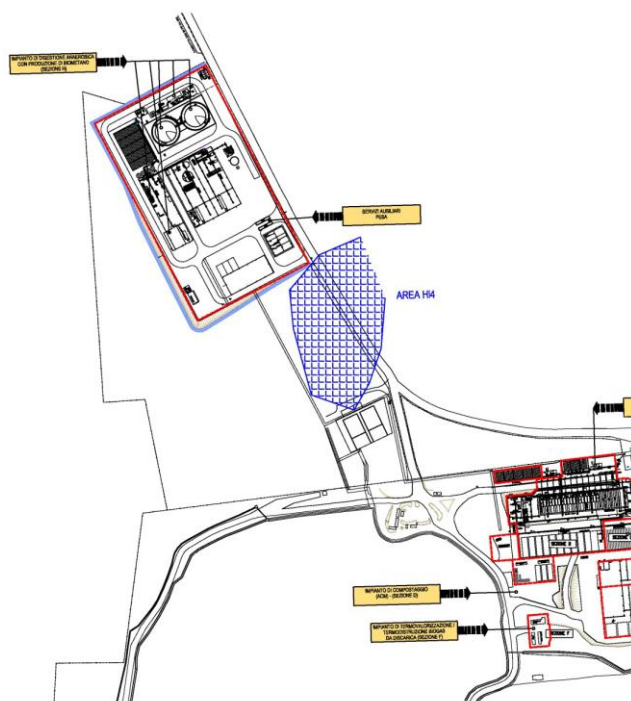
Perimetro dell'area di pericolosità idraulica Hi4 originariamente prevista all'atto delle redazioni del progetto a base della autorizzazione e ubicazione degli interventi ma non più vigente
